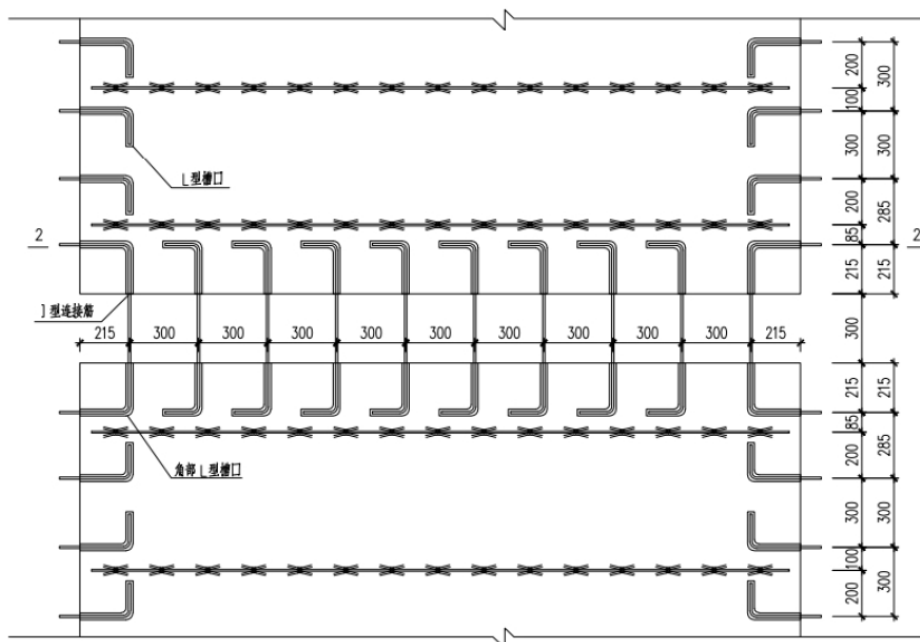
不出筋叠合板后浇区]型连接筋平面图
